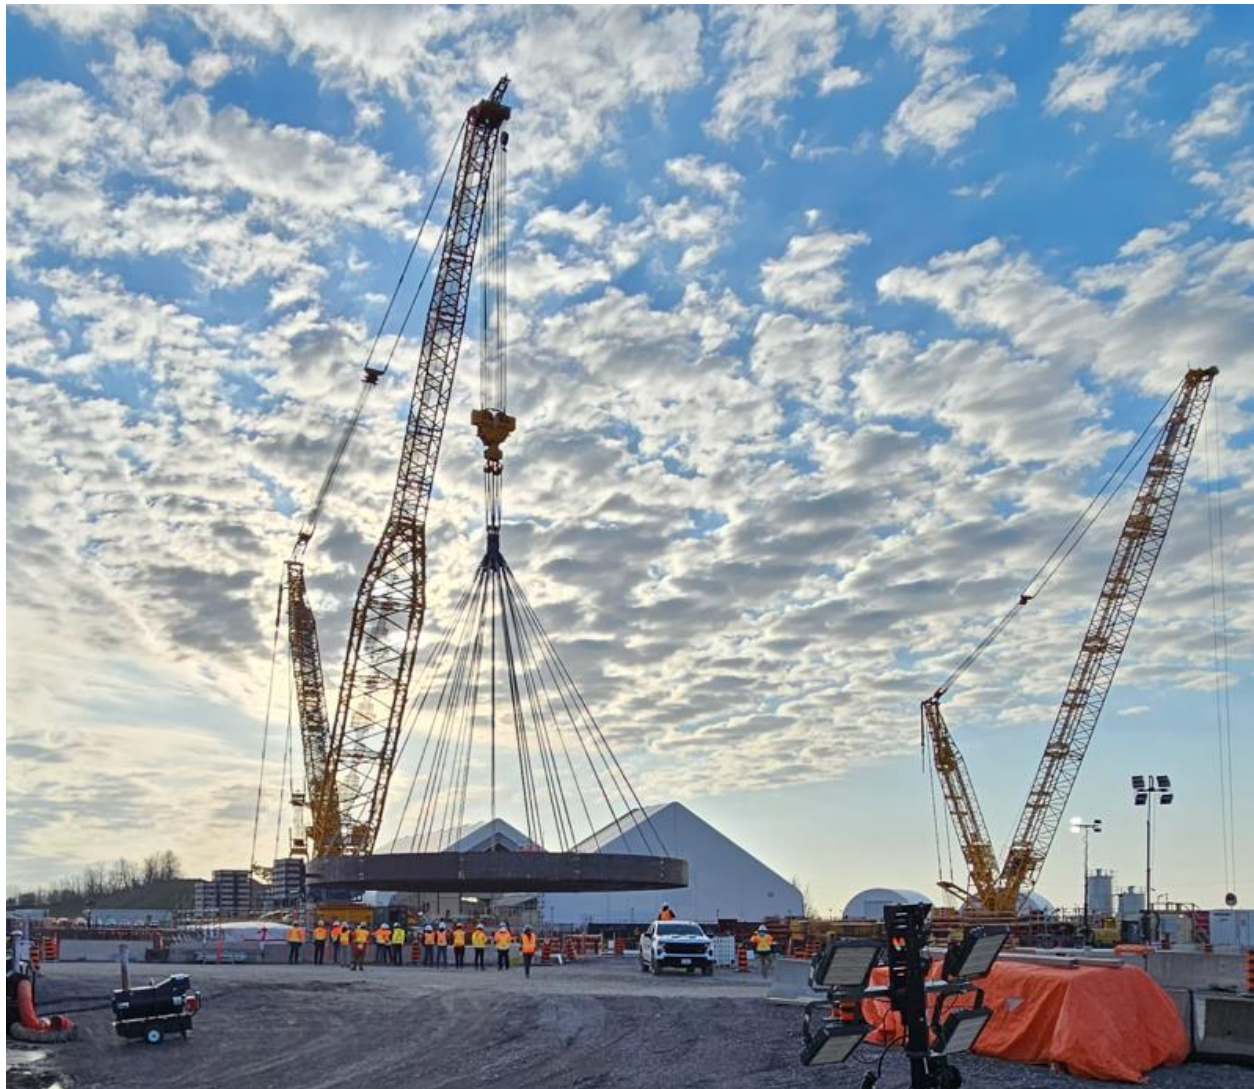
La dalle de fondation est abaissée dans le puits du bâtiment du réacteur. (Source : personnel de la CCSN, avril 2026)
